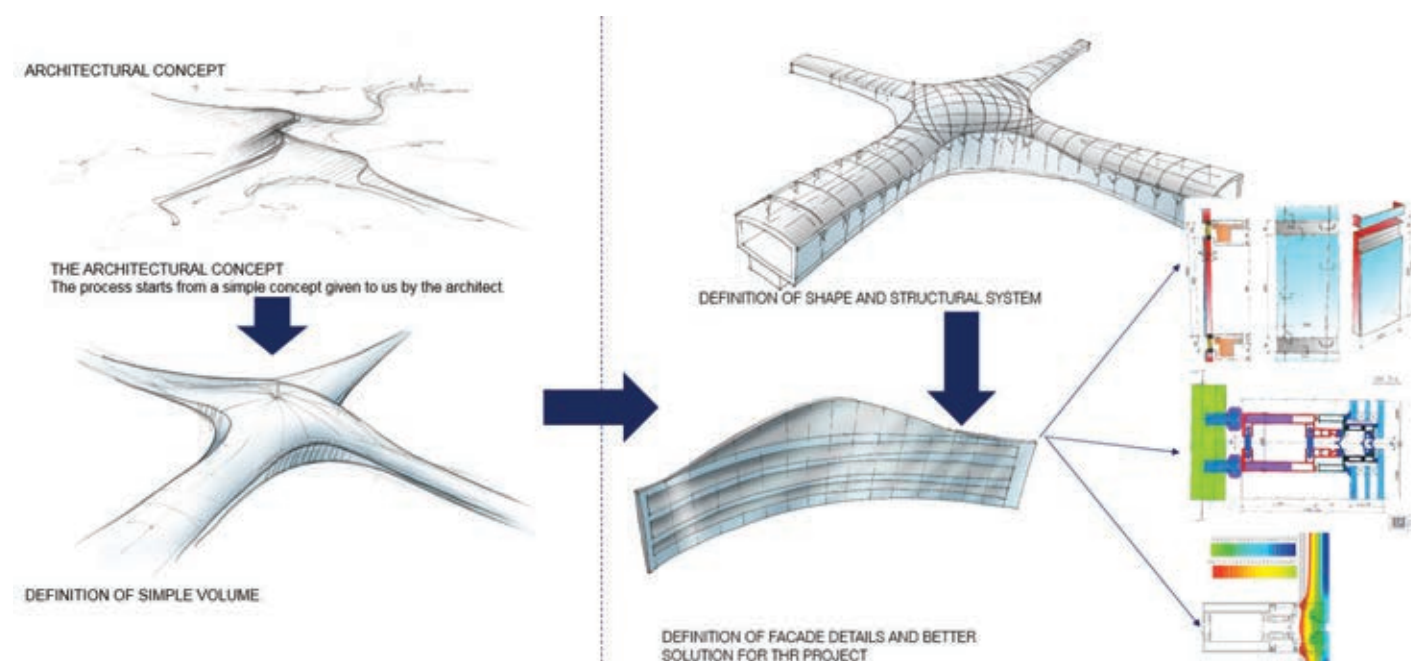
Schema fasi del progetto (dallo schizzo al dettaglio)
